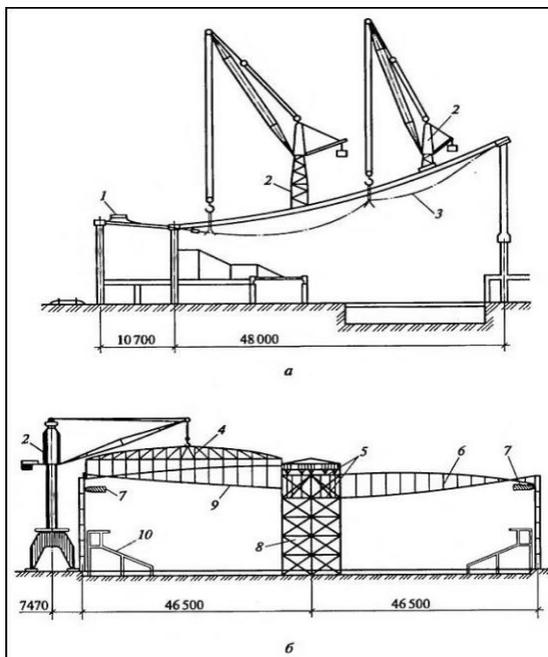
Технологические схемы перекрытия больших пролетов висячими конструкциями: а — вантовыми канатами; б — вантовыми фермами; 1 — электролебедка; 2 — башенные краны. 3 — вантовый канат; 4 — траверса, 5 — постоянная цилиндрическая опора из двух колец и стоек; б — установленная ферма. 7 — опорное железобетонное кольцо; 8 — временная монтажная опора; 9 — монтируемая вантовая ферма, 10 — трибуна
